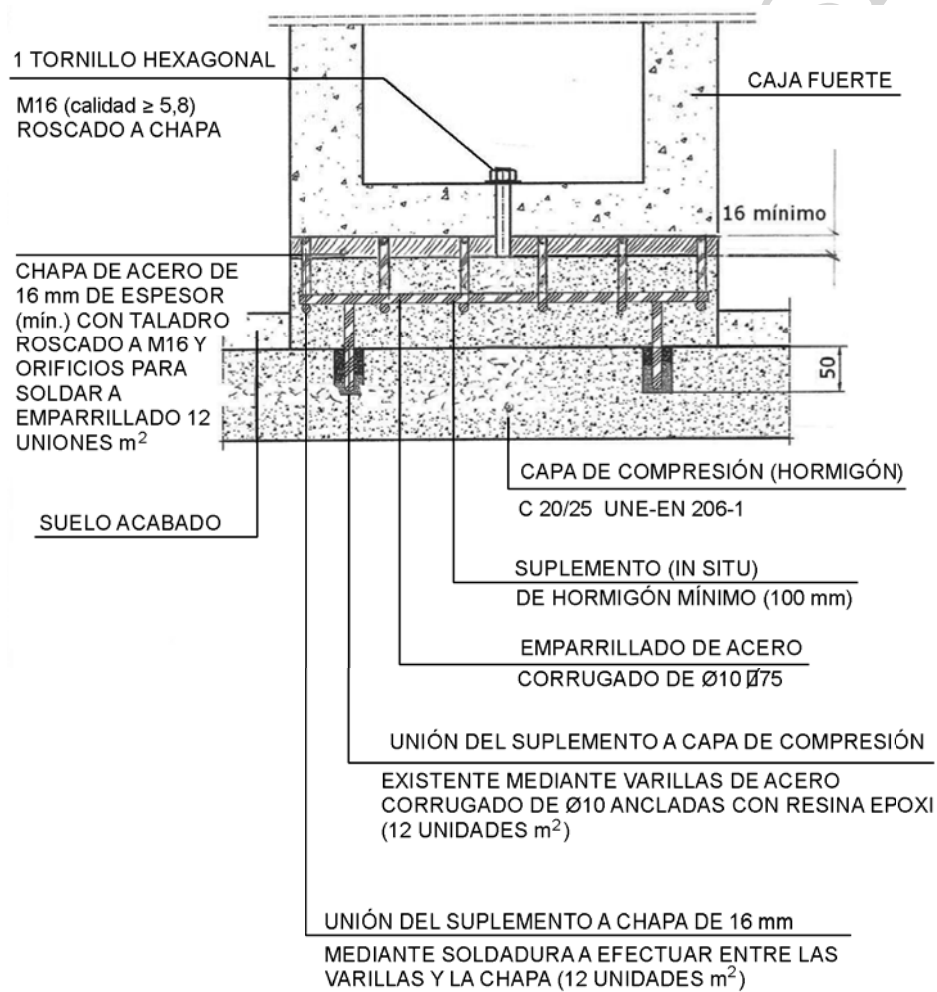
Anclaje mecánico en losa de hormigón y chapa de acero
